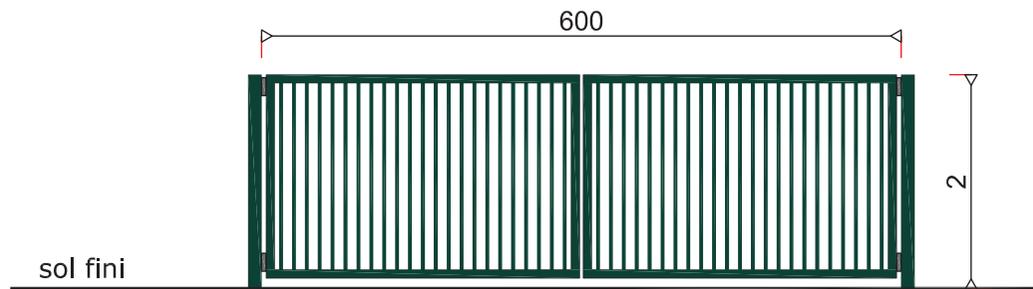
ELEVATION DE LA CLOTURE- échelle 1/50
